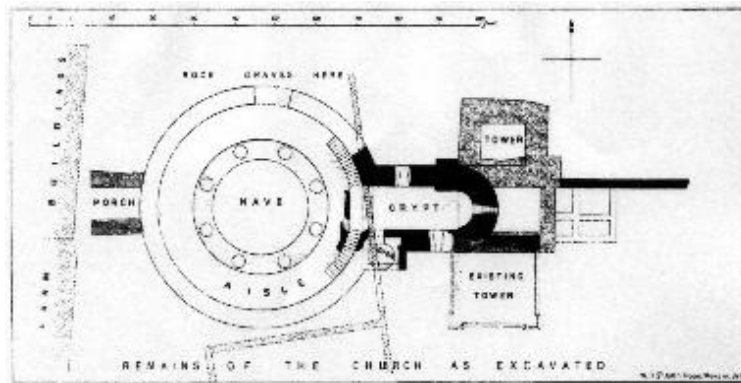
Grundriss, Temple Bruer, um 1186-1200.
